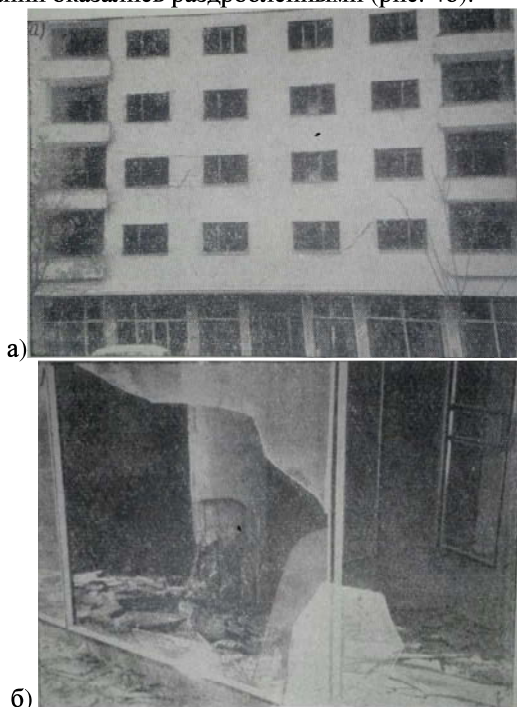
Последствия землетрясения в Скопье (Югославия) 26 июля 1963г; а) наклон каркаса первого этажа с сильно ослабленным заполнением; б) разрушение опорных участков колонн этого этажа
